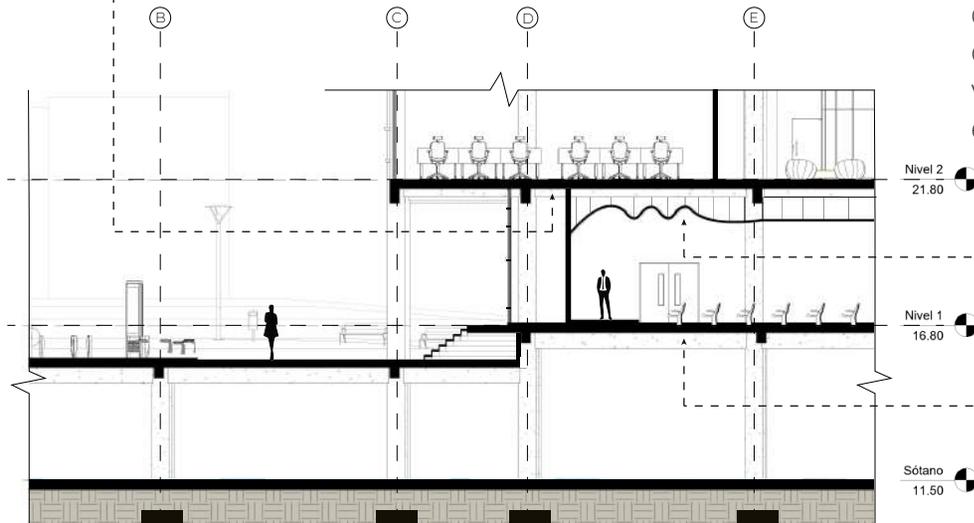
Detalle Y-Y' en sección del proyecto y ubicación en planta.
